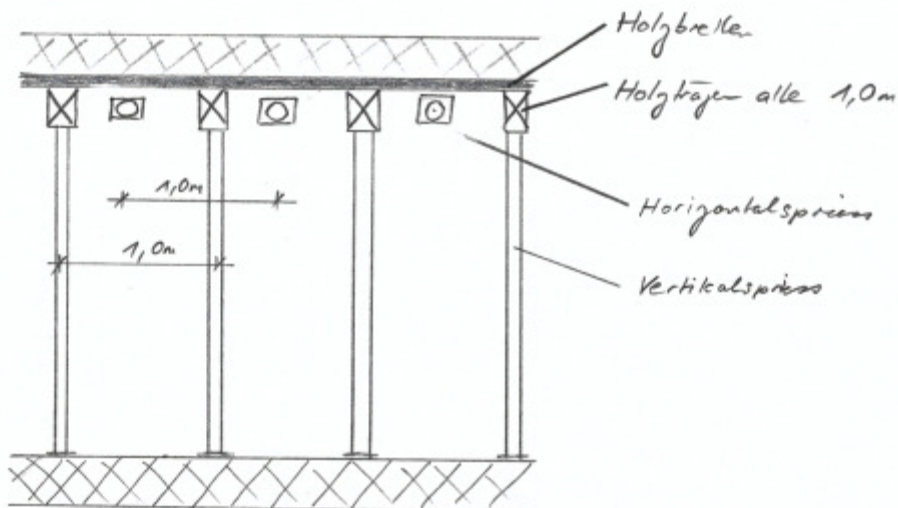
Schutzgerüst PU (Längsschnitt)
